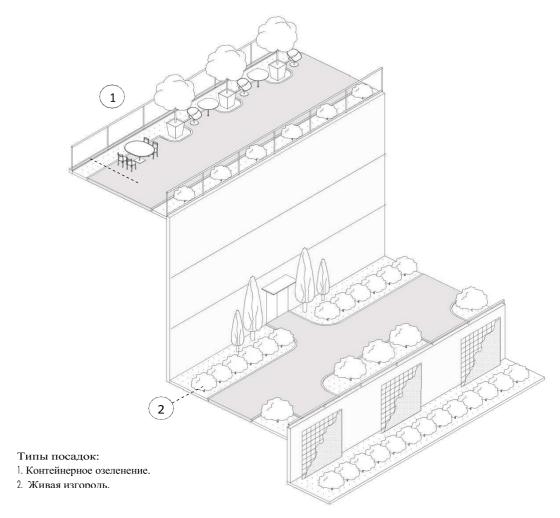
Рекомендуемые типы зеленых насаждений, высаживаемых на эксплуатируемой кровли.
